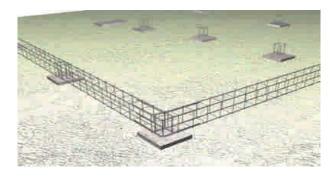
4: Fundación continua, pilotes de hormigón con viga de fundación.
